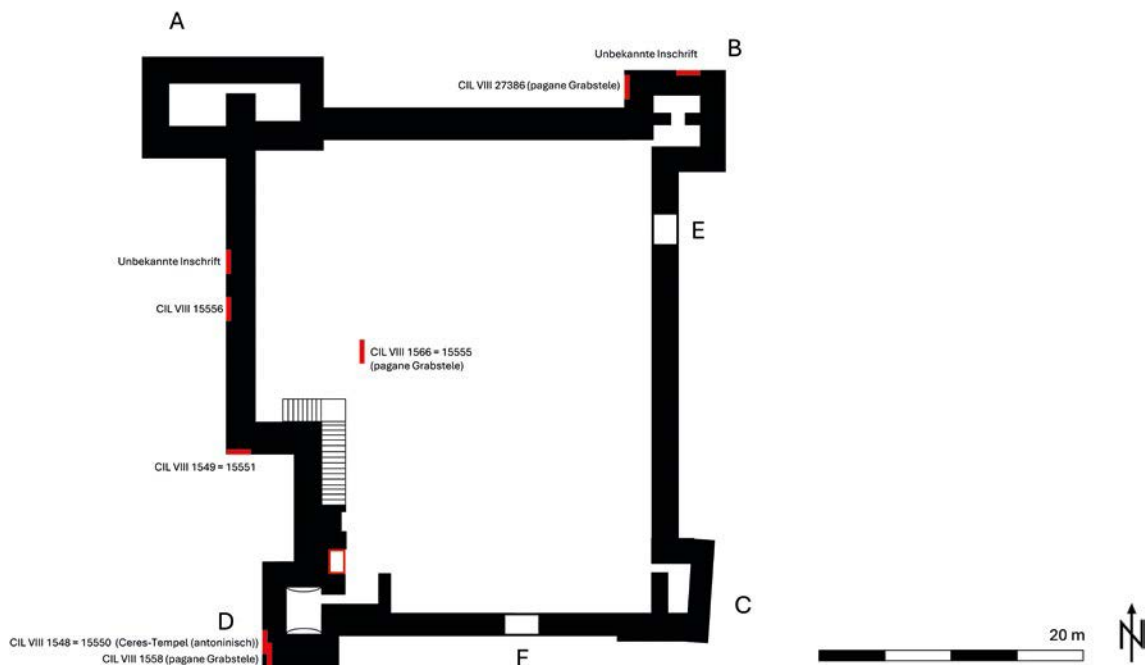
Agbia. Grundriss der Festung mit Inschriftenspolien (P. Margreiter)
